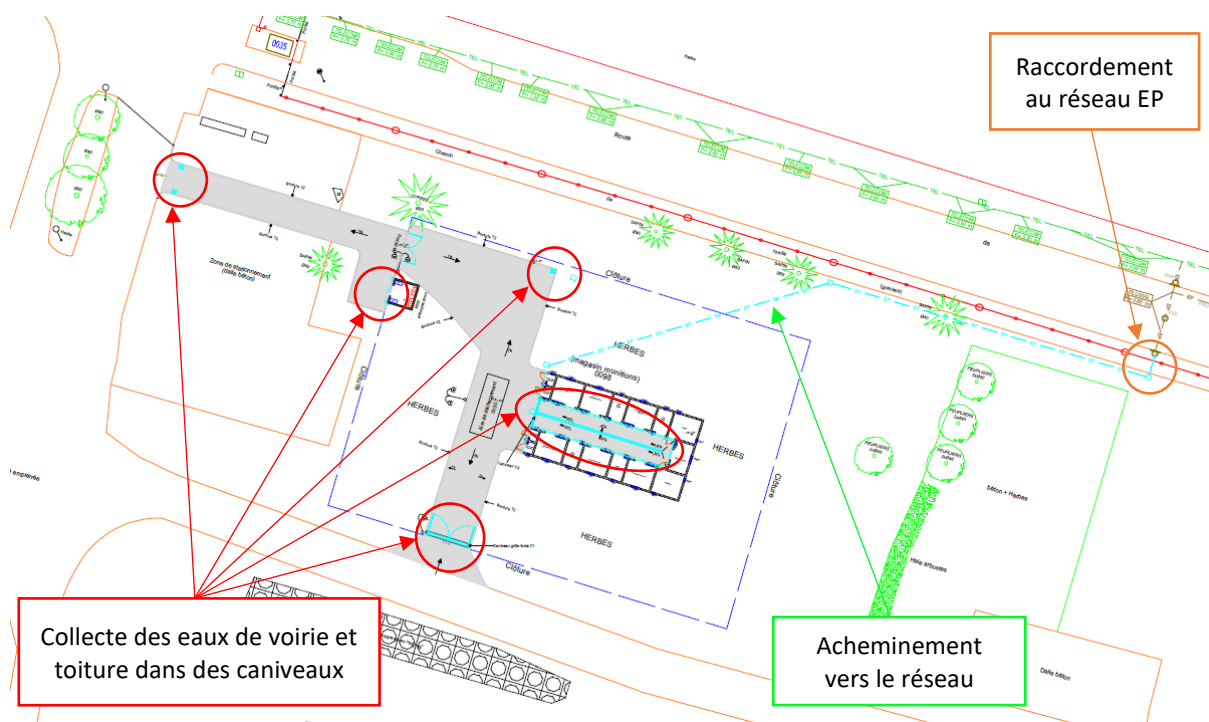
Localisation des ouvrages de gestion des eaux pluviales sur le plan de masse du projet
